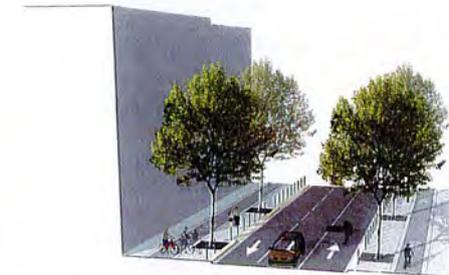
PLATEAU TRAVERSANT AUX CARREFOURS SINGULIERS
